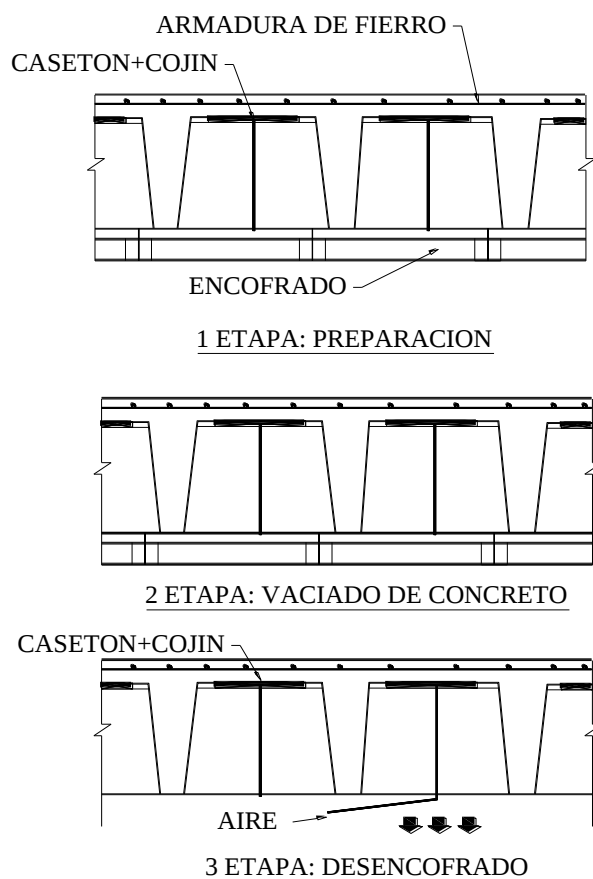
Etapas a seguir para realizar el sistema con encofrado recuperable.
